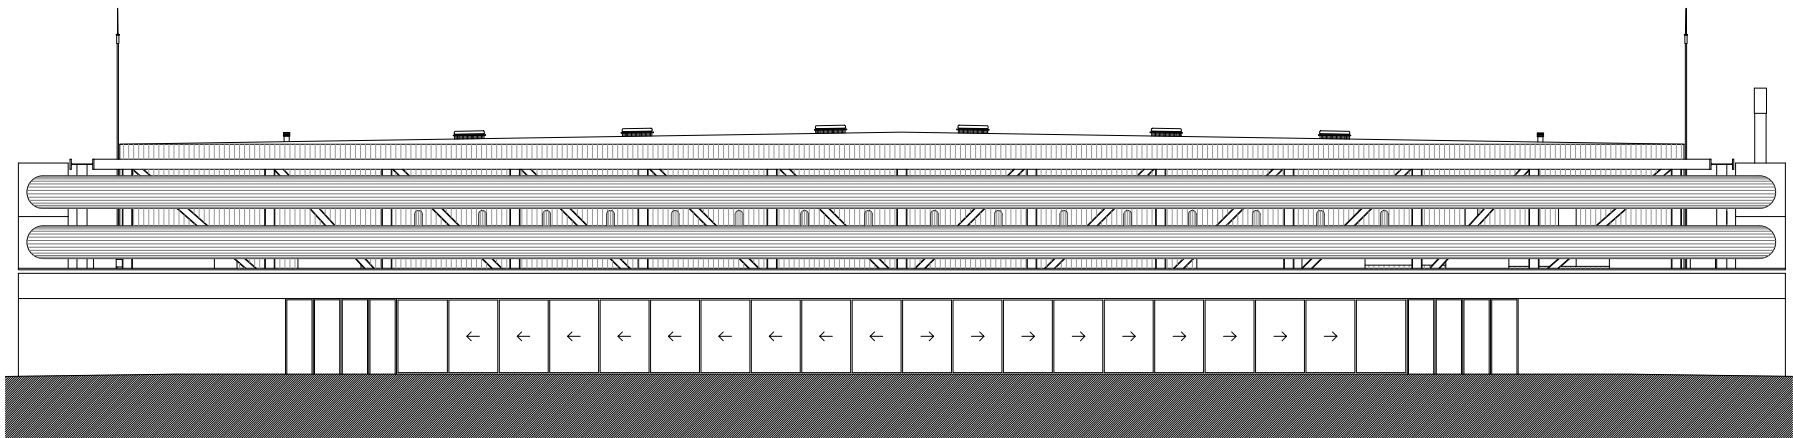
Alzado norte do Centro Cultural. Escala 1/300.
